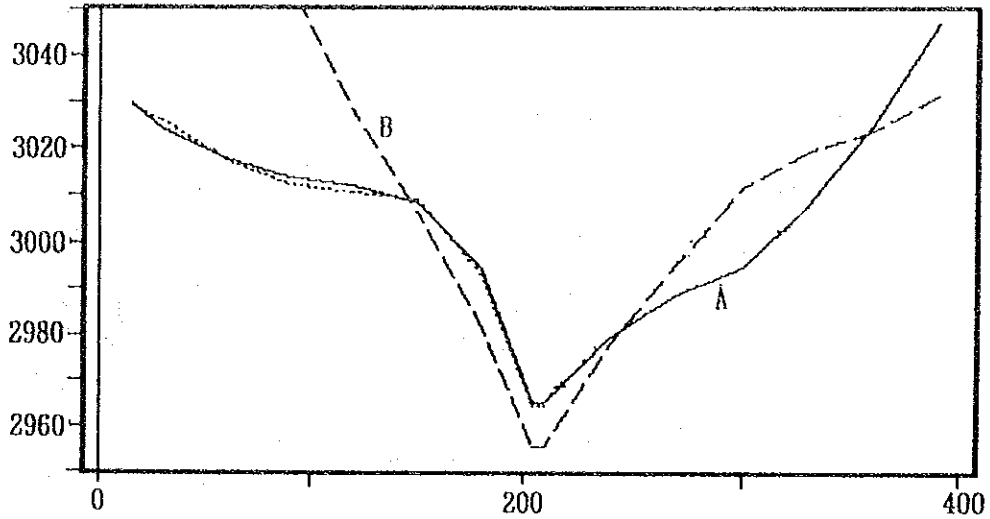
Secciones Transversales de los Sitios Propuestos para la Presa
